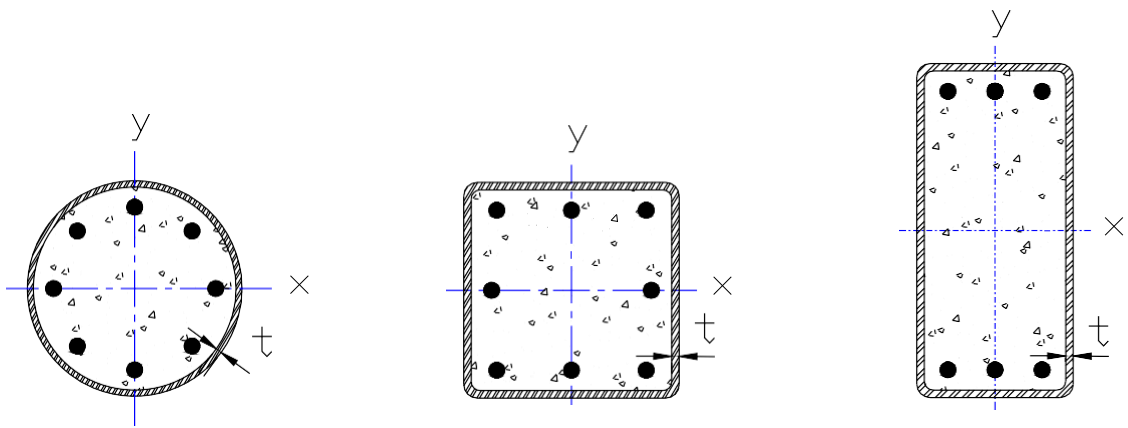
Secciones de los perfiles tubulares rellenas de concreto con acero de refuerzo longitudinal
